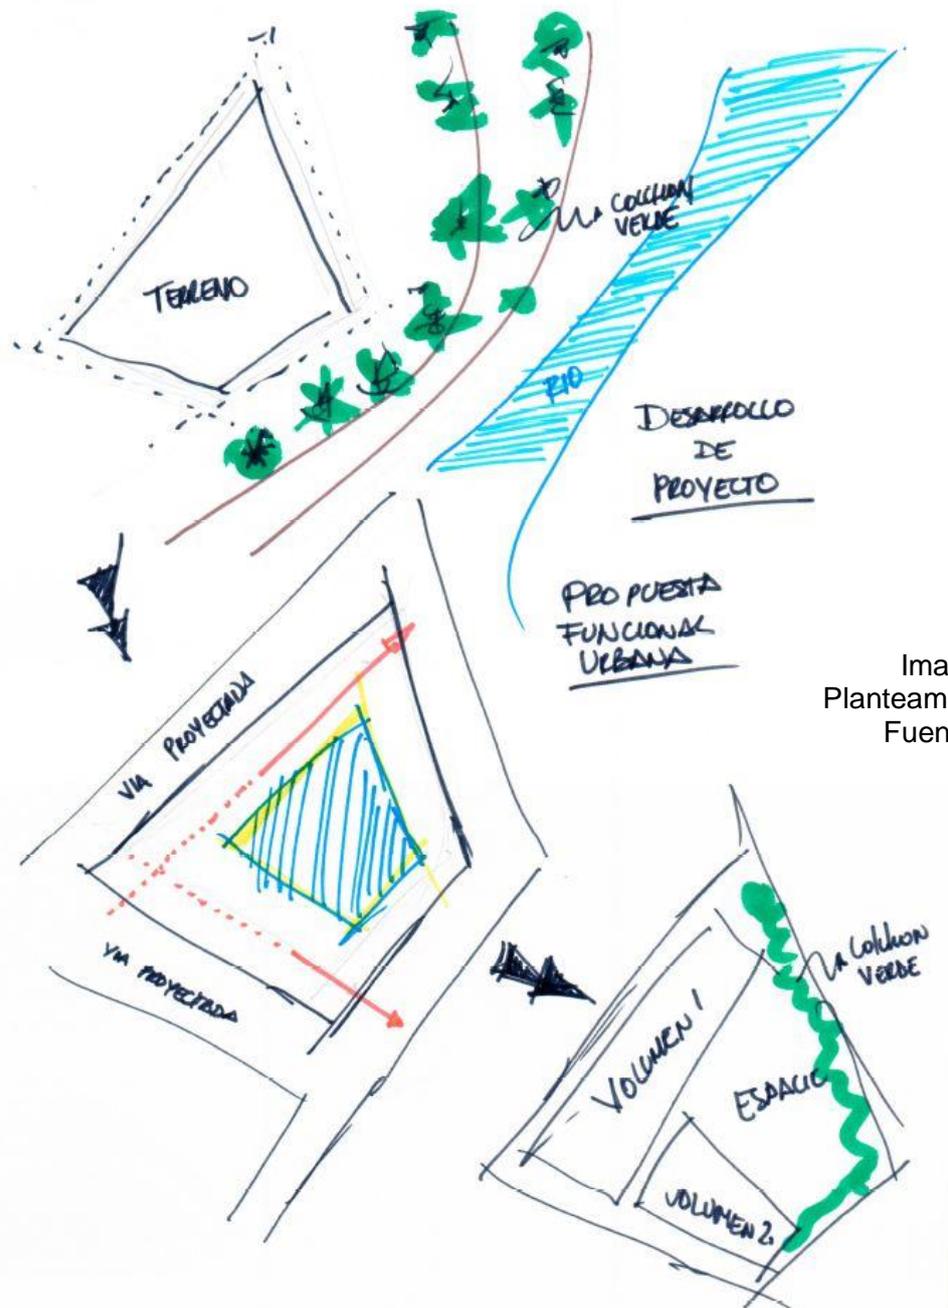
Boceto de Planteamiento Arquitectónico
